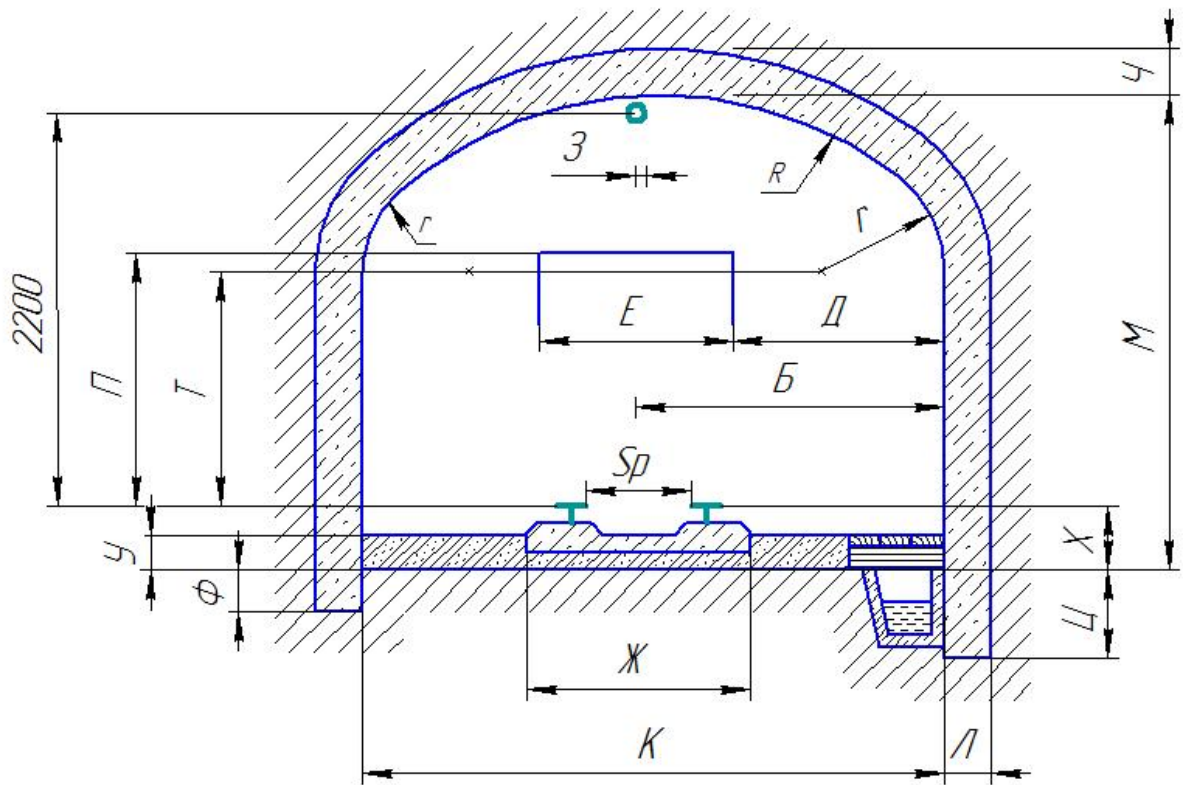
Поперечное сечение однопутевой горизонтальной выработки с бетонной монолитной крепью
